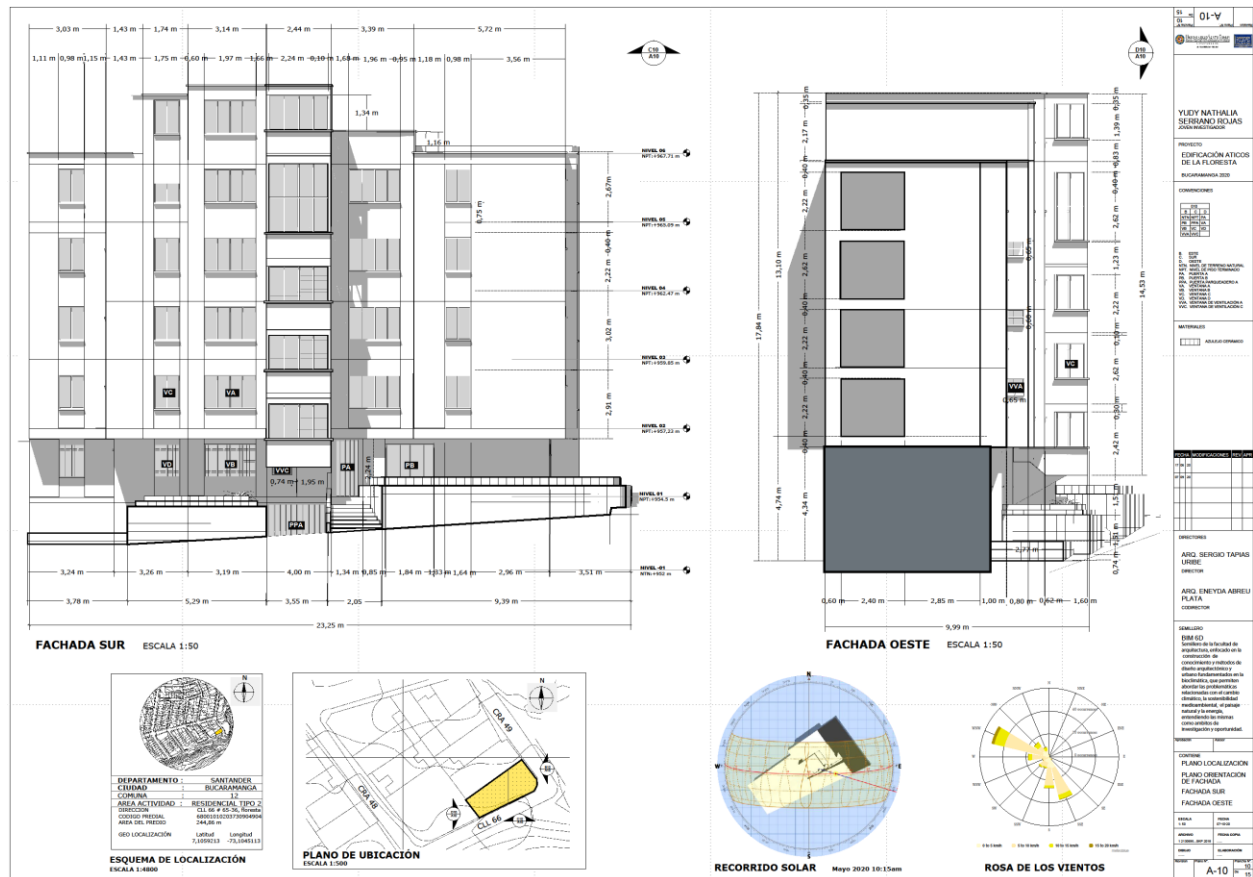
Levantamiento arquitectónico, plancha 10 (Localización, componente ambiental, fachada sur y fachada oeste) edificación “Áticos de la Floresta”, 1990.
